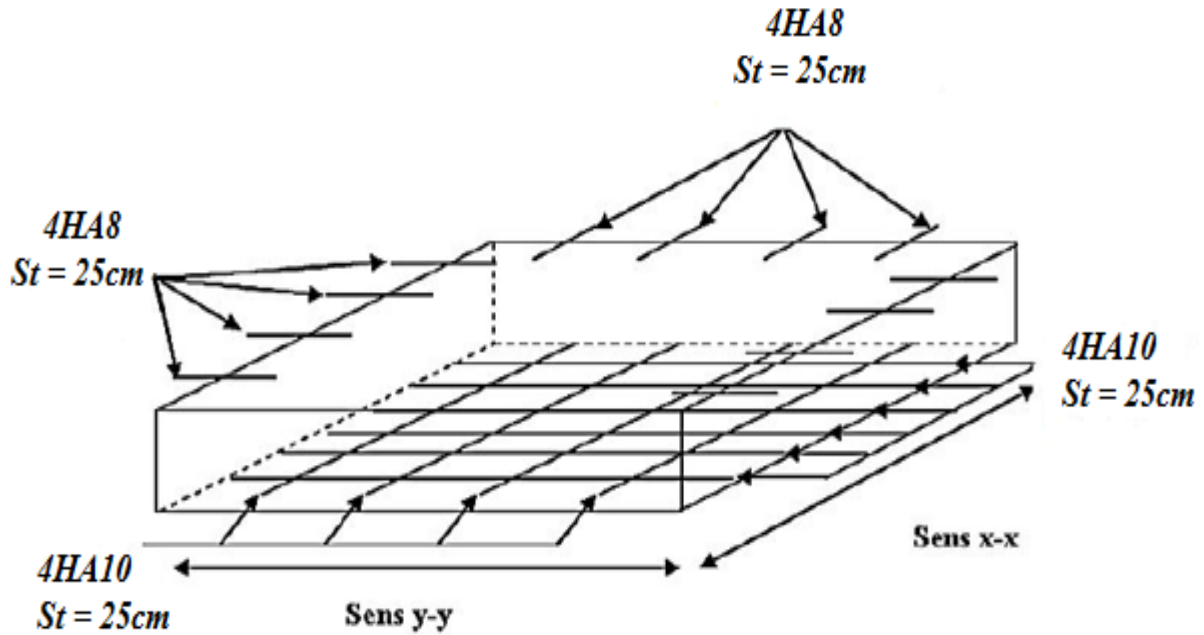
Schéma de ferrailage de la dalle sur quatre appuis (terrasse)
